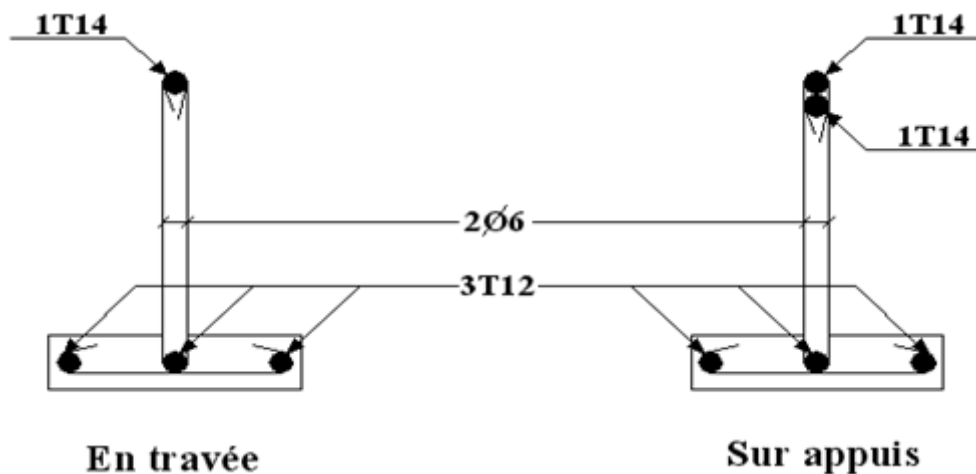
Ferrailage des poutrelles en travée et en appuis.
